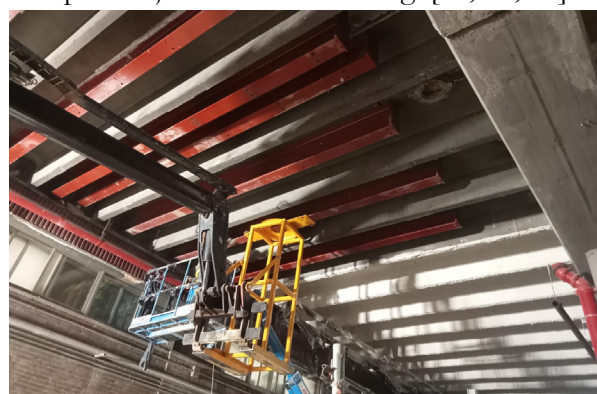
Montaje del primer tramo de las vigas metálicas de refuerzo
